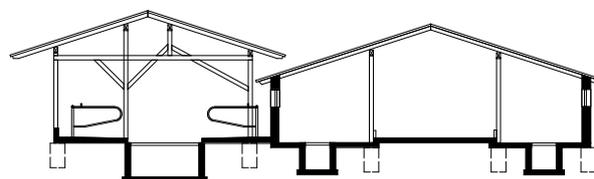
Bauzeichnung Altgebäude Betrieb B
